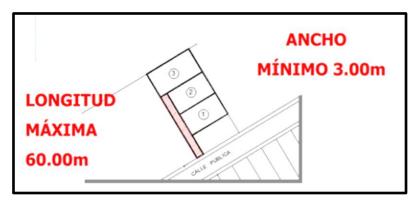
Ancho vía fraccionamiento tres lotes.
